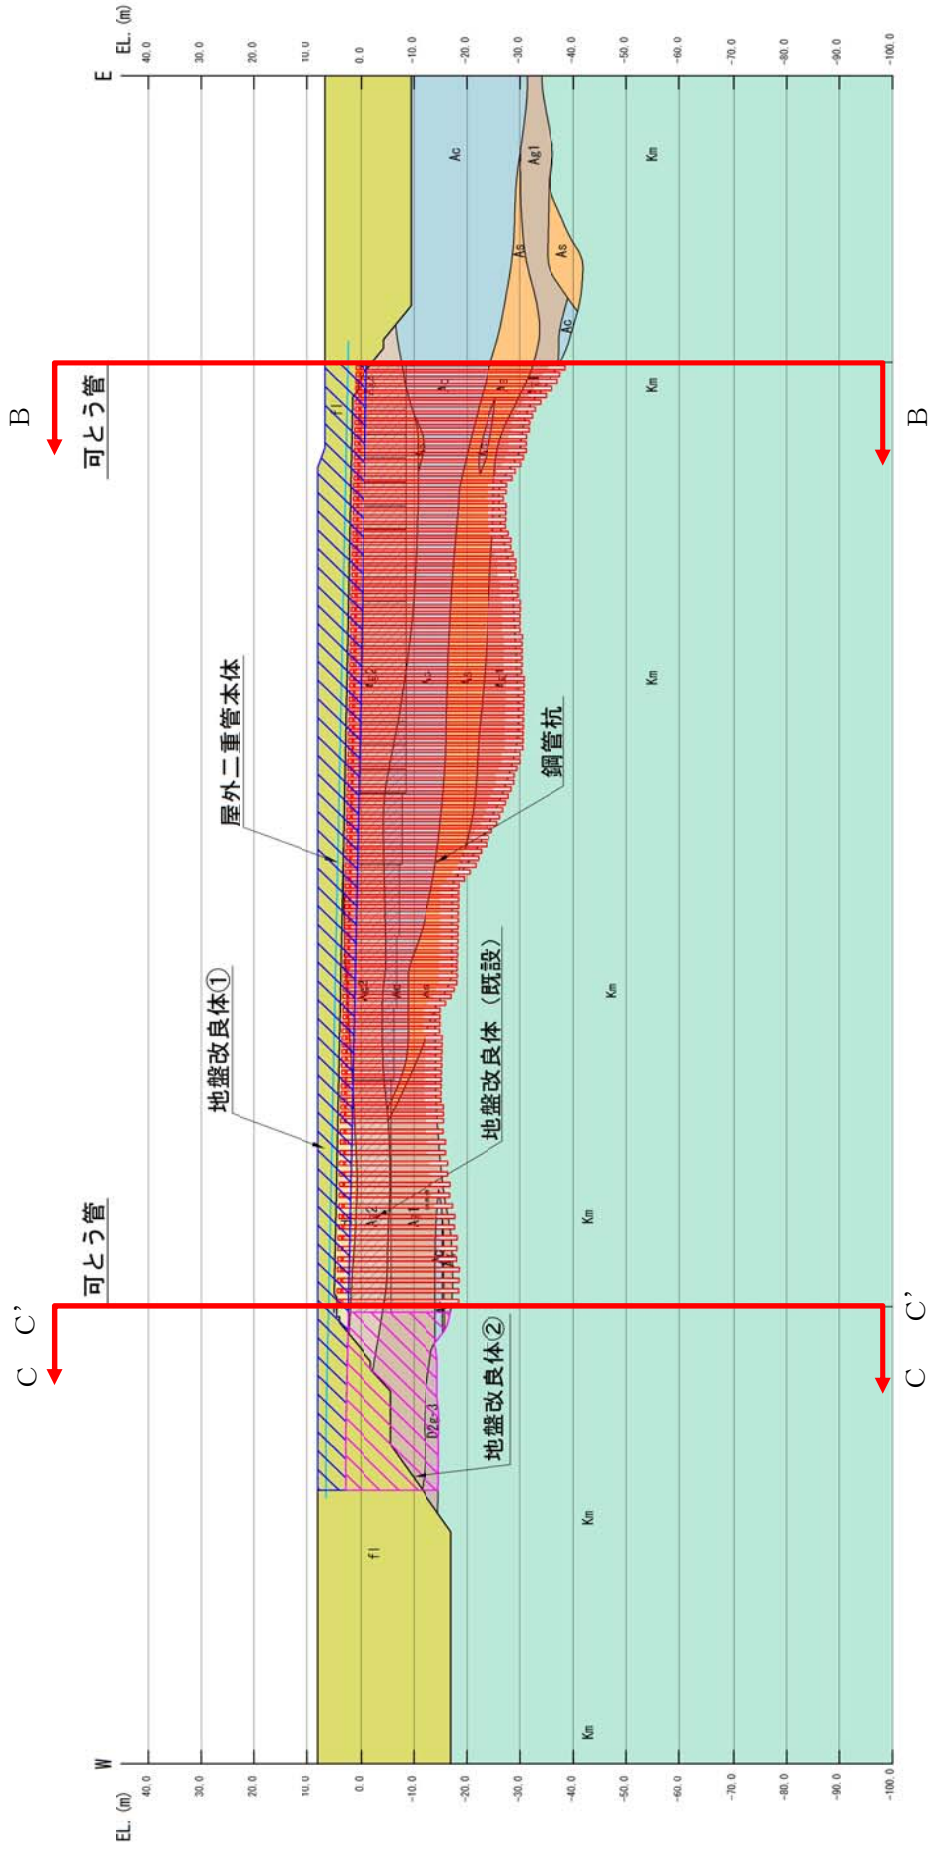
(1) 屋外二重管の評価対象断面図 (A-A 断面)
